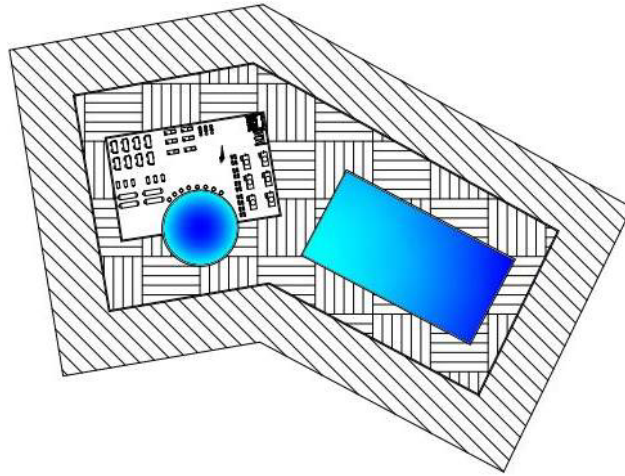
Planta Sótano, nivel -3.00m. (2019)
